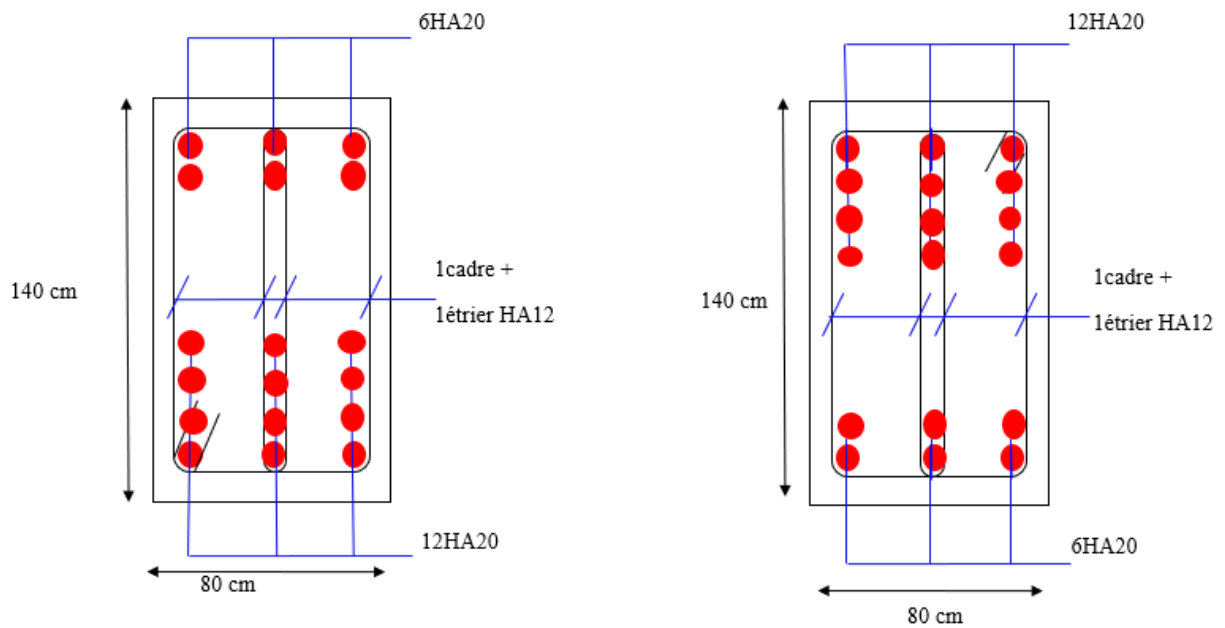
Ferrailage de poutres en travée et en appui respectivement
